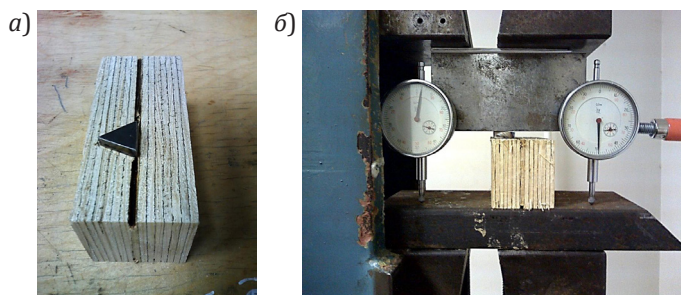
Проведение испытаний для получения коэффициента постели для LVL треугольным штампом: а – образец LVL с пропилом; б – схема испытательной установки
